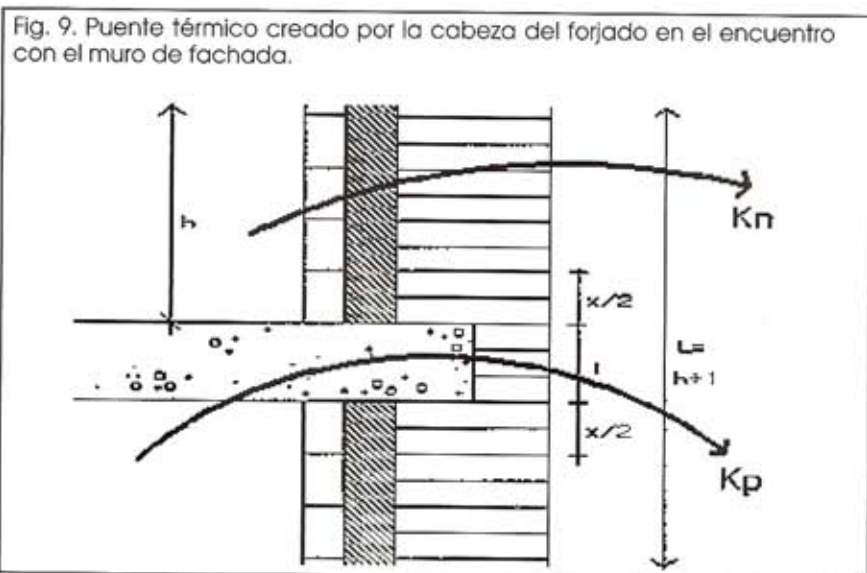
Puente térmico creado por la cabeza del forjado en el encuentro con el muro de fachada.
